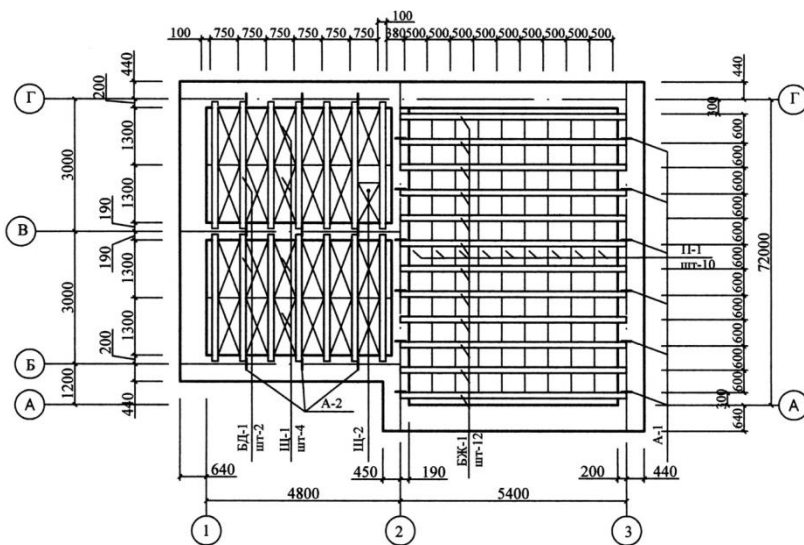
План перекрытия по деревянным и железобетонным балкам
